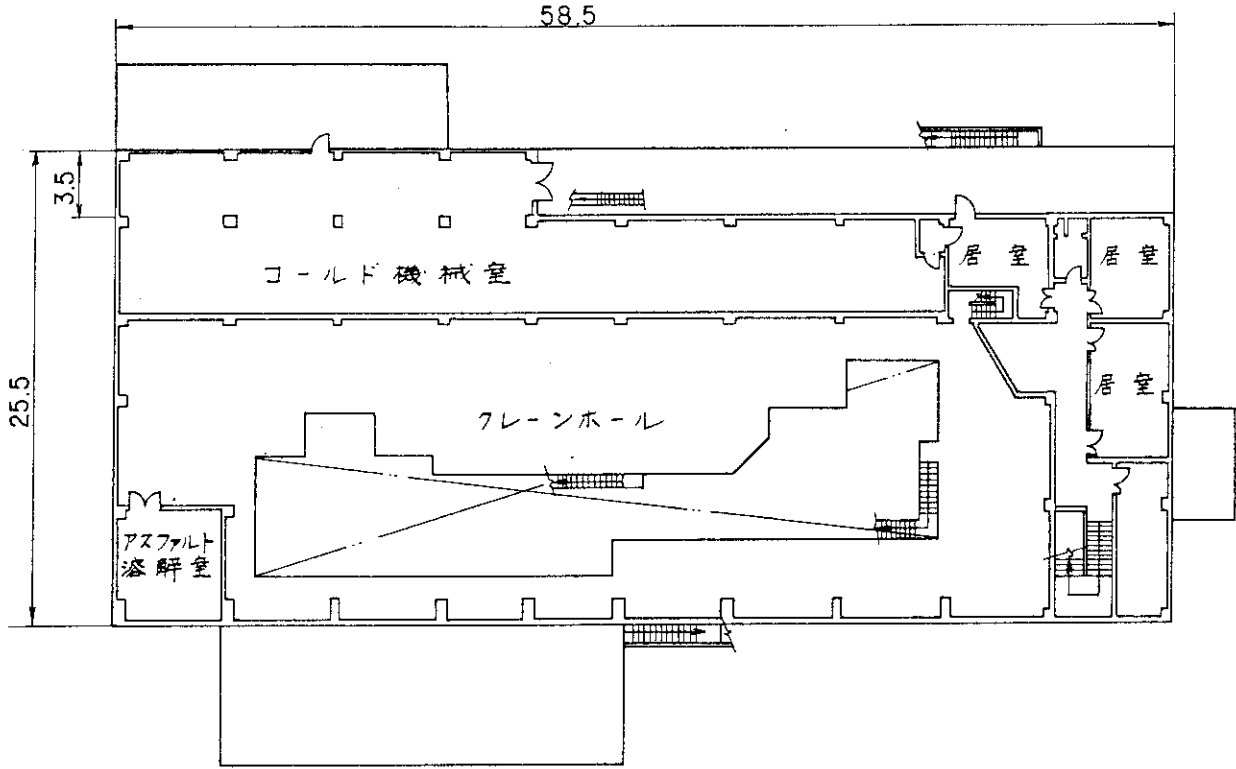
第2廃棄物処理棟2階平面図 (単位:m)
